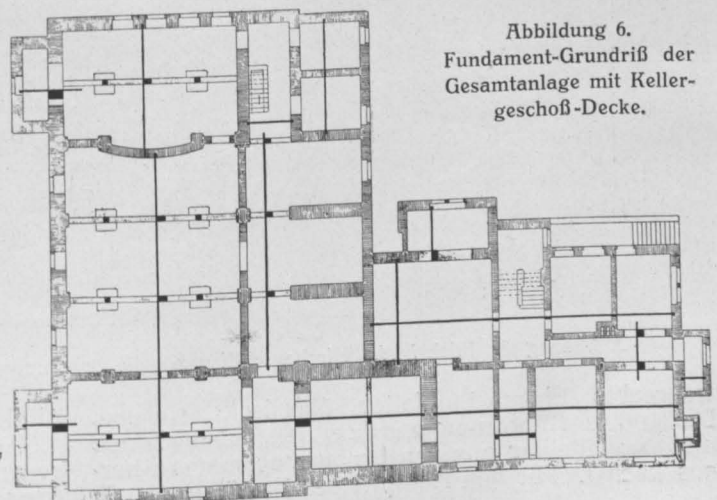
Fundament-Grundriß der Gesamtanlage mit Kellergeschoß-Decke.
